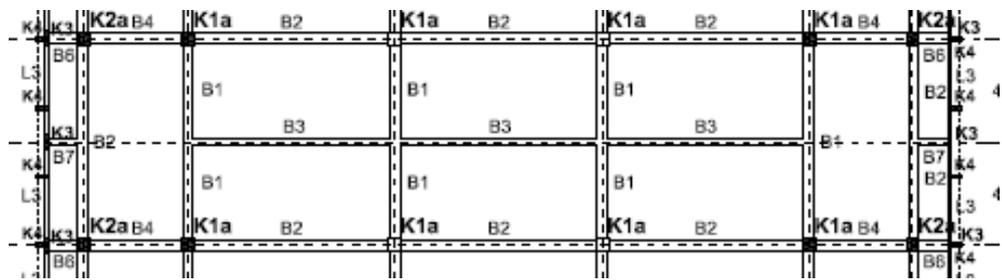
Denah Pelat dan balok lantai 2 Gedung Kantor Tahap II KPPD di Kab.Sleman
